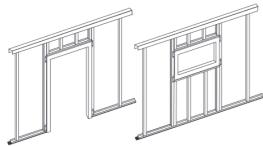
Detalle estructura portante de acero. Fuente: ATEDY
